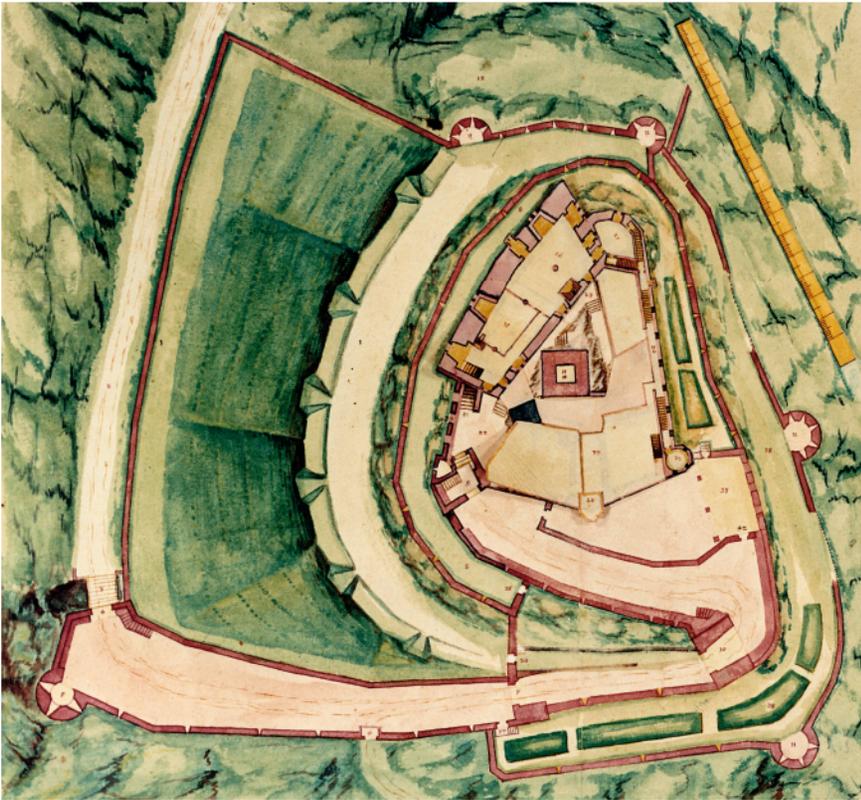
Grundriss der Marksburg (Ausschnitt) von Wilhelm Dilich 1608, mit den drei Gartentypen, kolorierte Handzeichnung. Original: Gesamthochschul-Bibliothek Kassel (aus: Frank/Friedhoff, S. 49).
